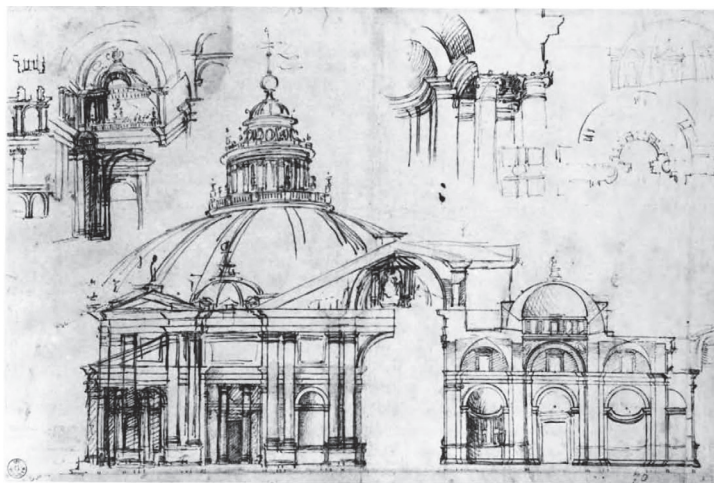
圣乔瓦尼教堂穹顶平面及剖面图
